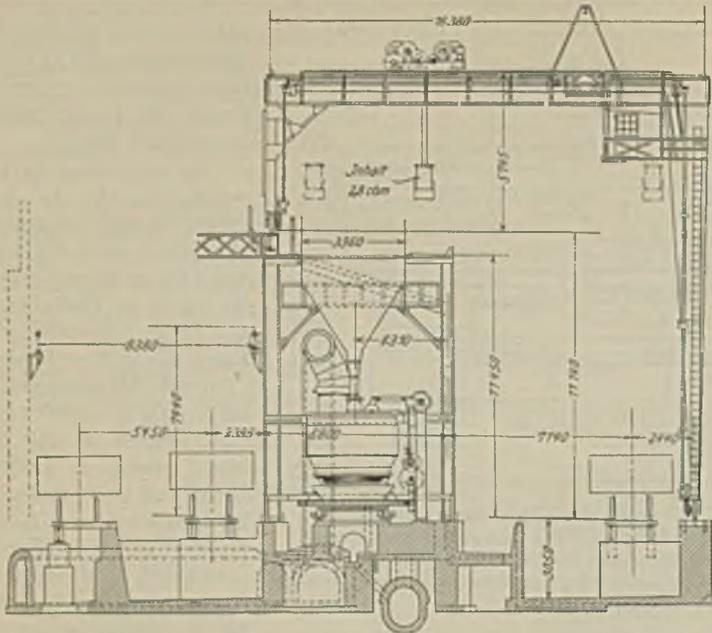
Querschnitt durch die Gaserzeugeranlage der Inland Steel Company.
